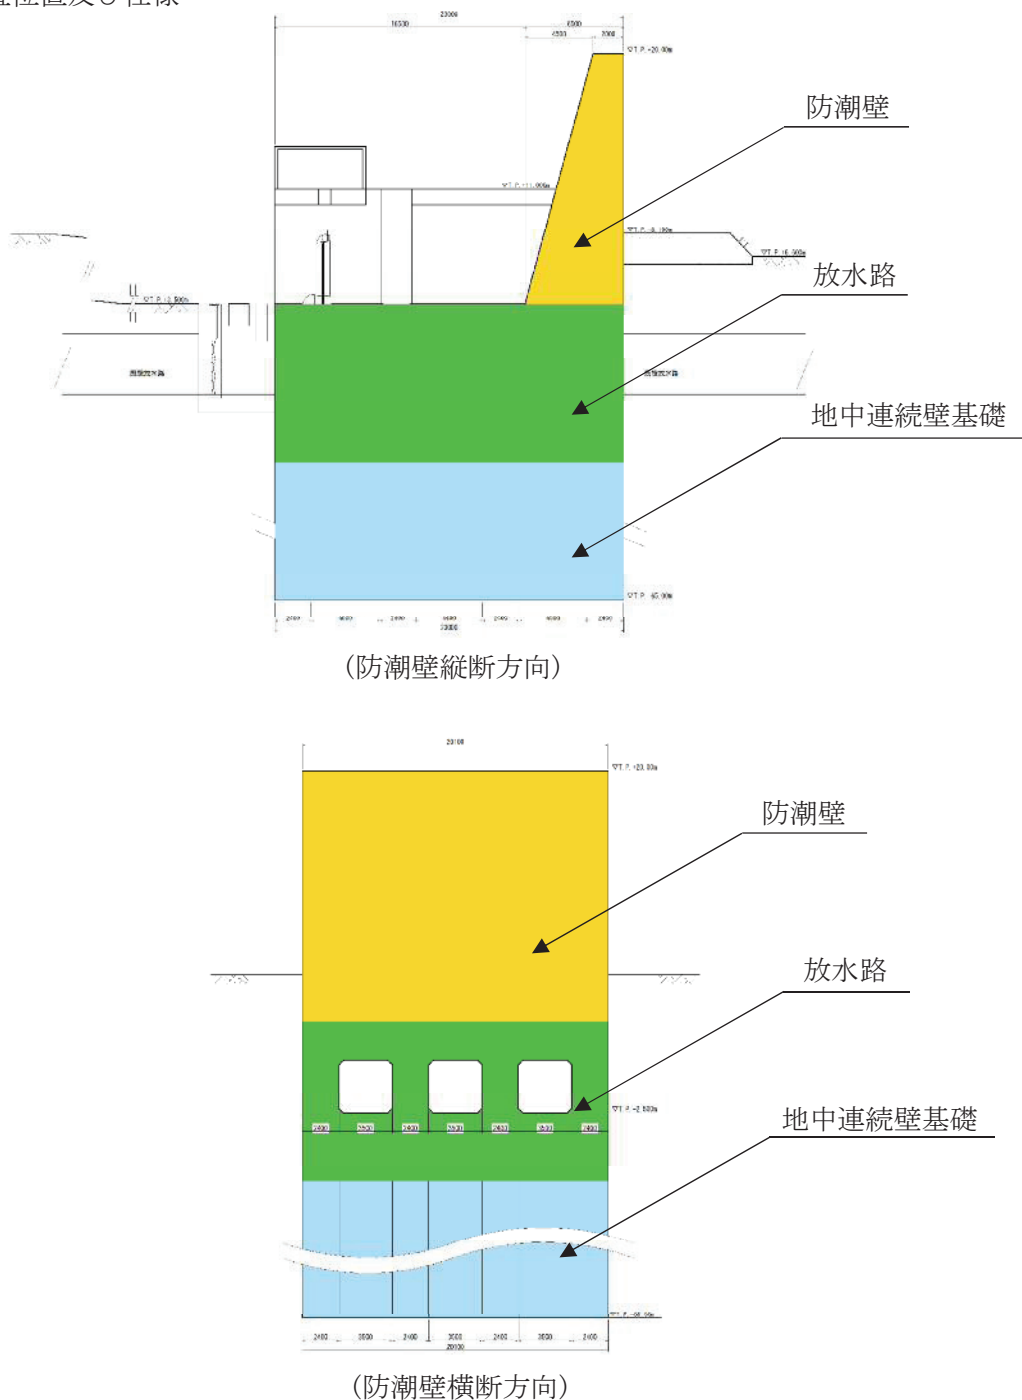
防潮堤（鉄筋コンクリート防潮壁（放水路エリア））の照査位置図
